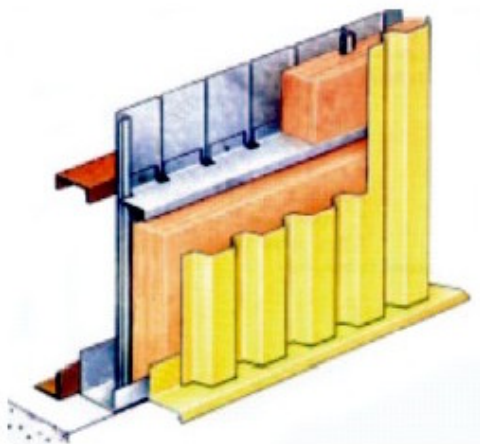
Exemplo de estruturação de um painel em aço com isolamento térmico.
